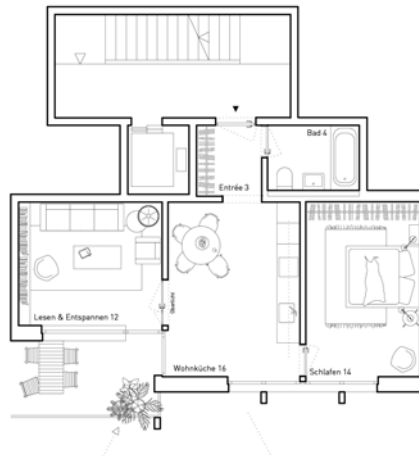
Tommy & Annika: Wohnungsgrundriss 2.5-Zimmer-Whg.
